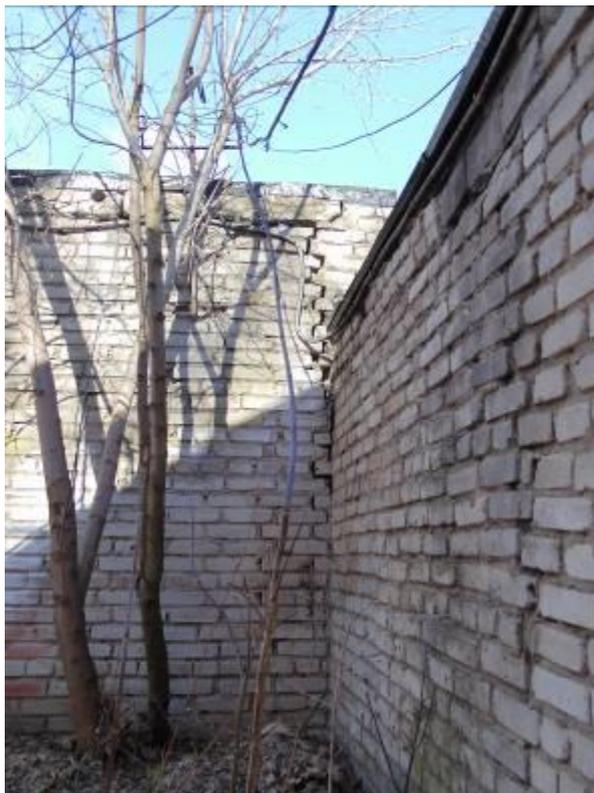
Часть гаражного комплекса (справа от фасада с въездными воротами).
